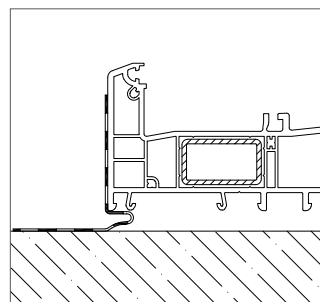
Примеры устройства гидроизоляции монтажных швов
